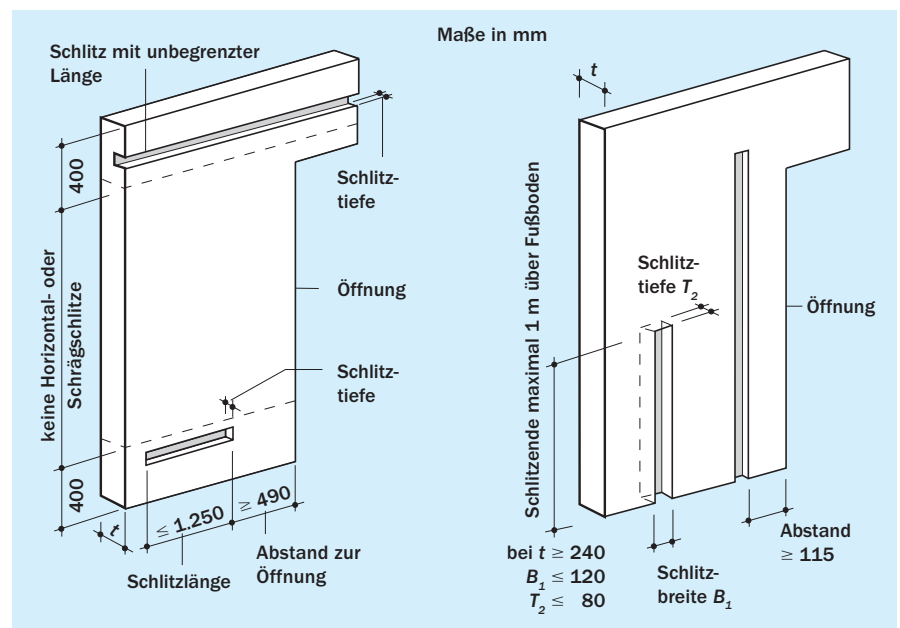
Nachträglich hergestellte horizontale und schräge Schlitze (links); nachträglich hergestellte vertikale Schlitze und Aussparungen (rechts)
